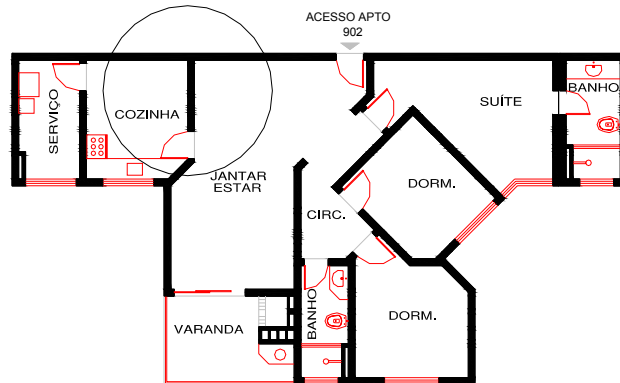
Planta Baixa do apartamento 902 – Estudo de caso A.
